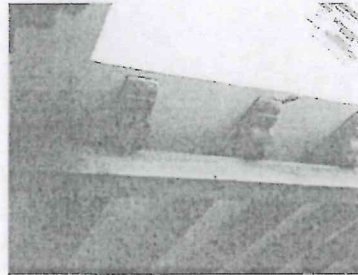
Fisuras por juntas frías entre el plafón y vigas de madera.
